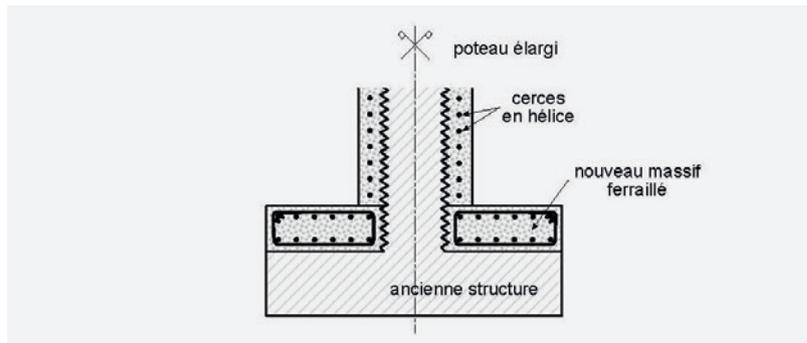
pas d'augmentation de la surface de la semelle.
